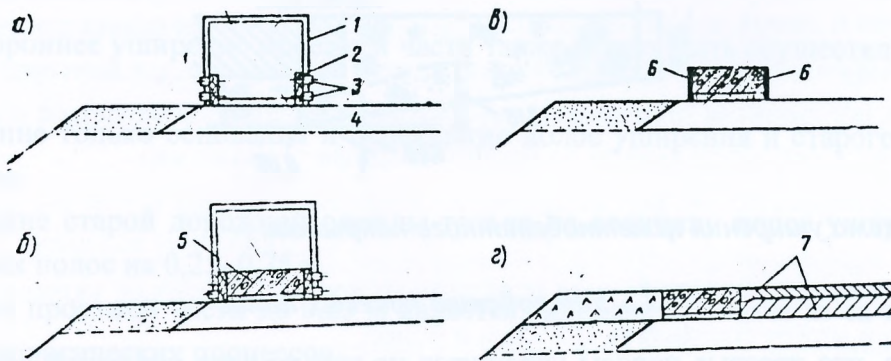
Последовательность устройства краевой полосы из монолитного бетона: а – установка опалубки; б – укладка бетона; в – снятие опалубки и обмазки боковых поверхностей битумом; г – укладка покрытия; 1 – металлическая рама; 2 – доски, поставленные на ребра; 3 – проушины; 4 – основание; 5 – бетон; 6 – смазки битумом; 7 – покрытие.
